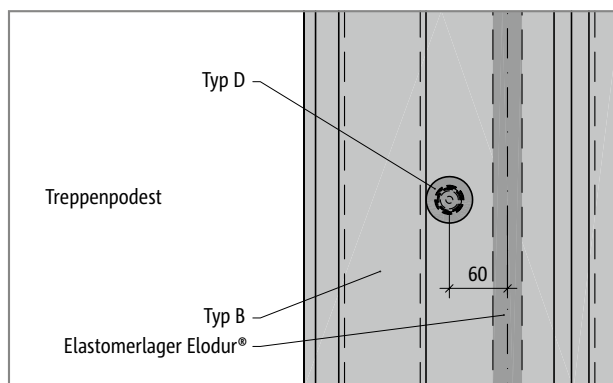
Schöck Tronsole® Typ B + Typ D: Detail A
